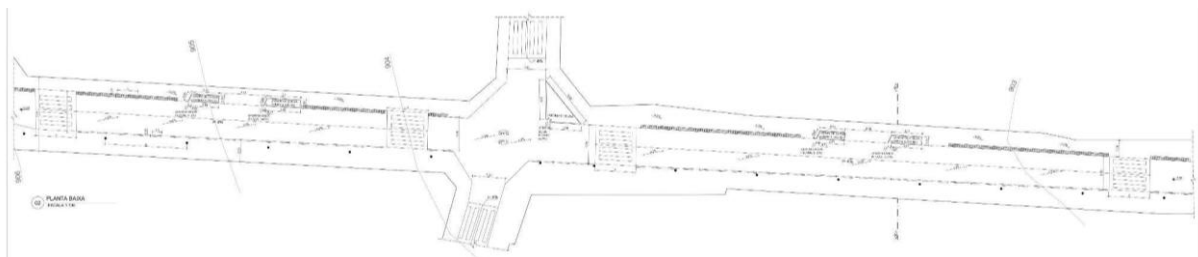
Planta Baixa. Fonte: Os autores (2025)
